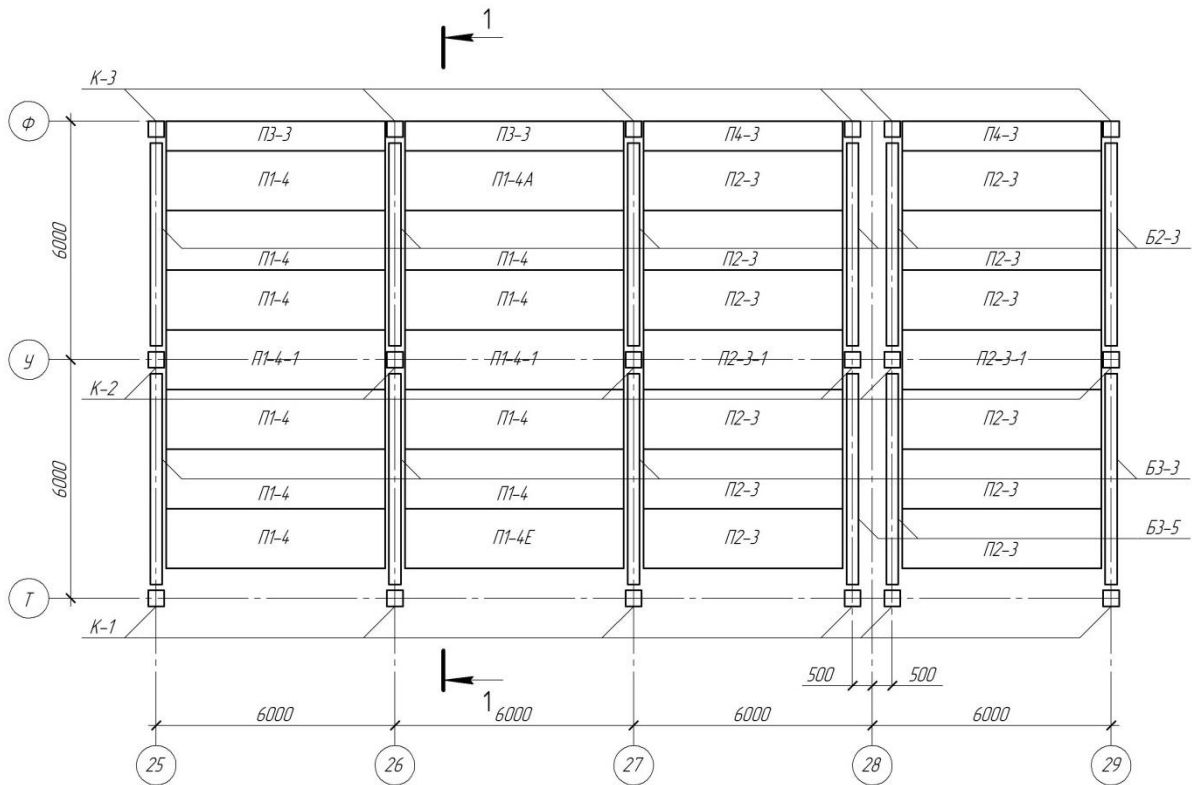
Схема расположения несущих элементов каркаса здания на отм. +4.200
